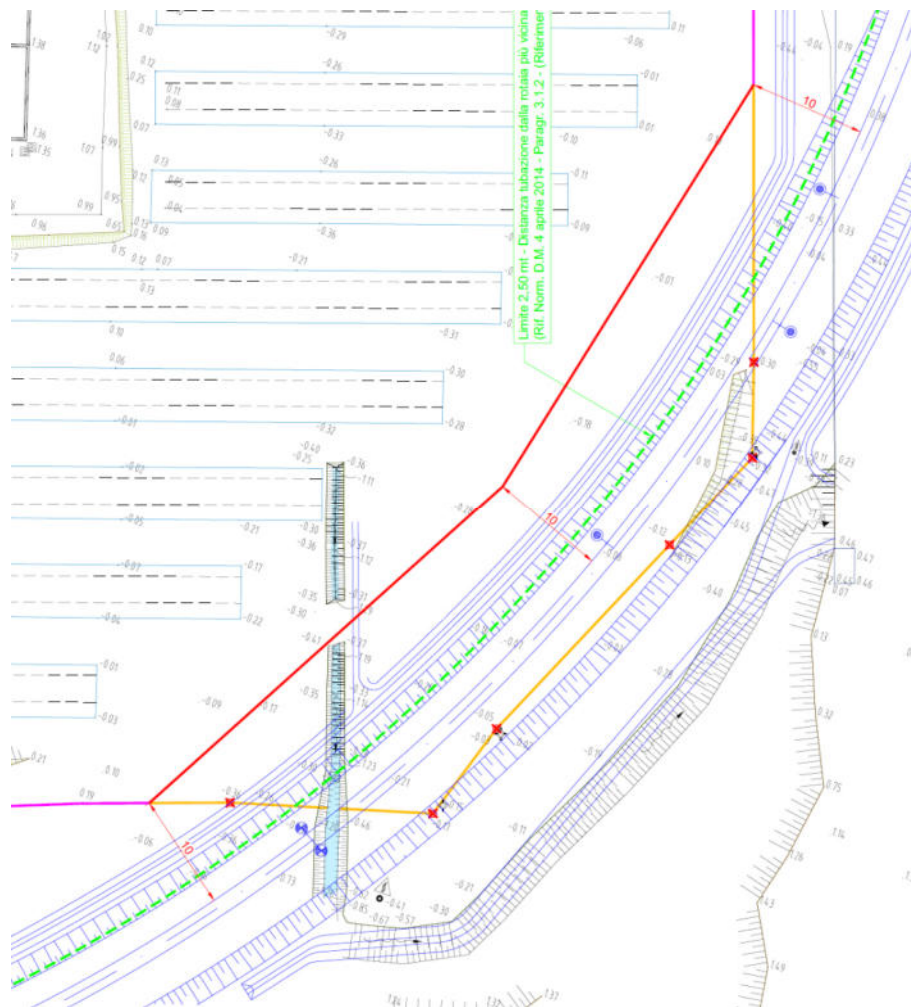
Planimetria spostamento azotodotto: in giallo condotta esistente, in azzurro nuovo tracciato
